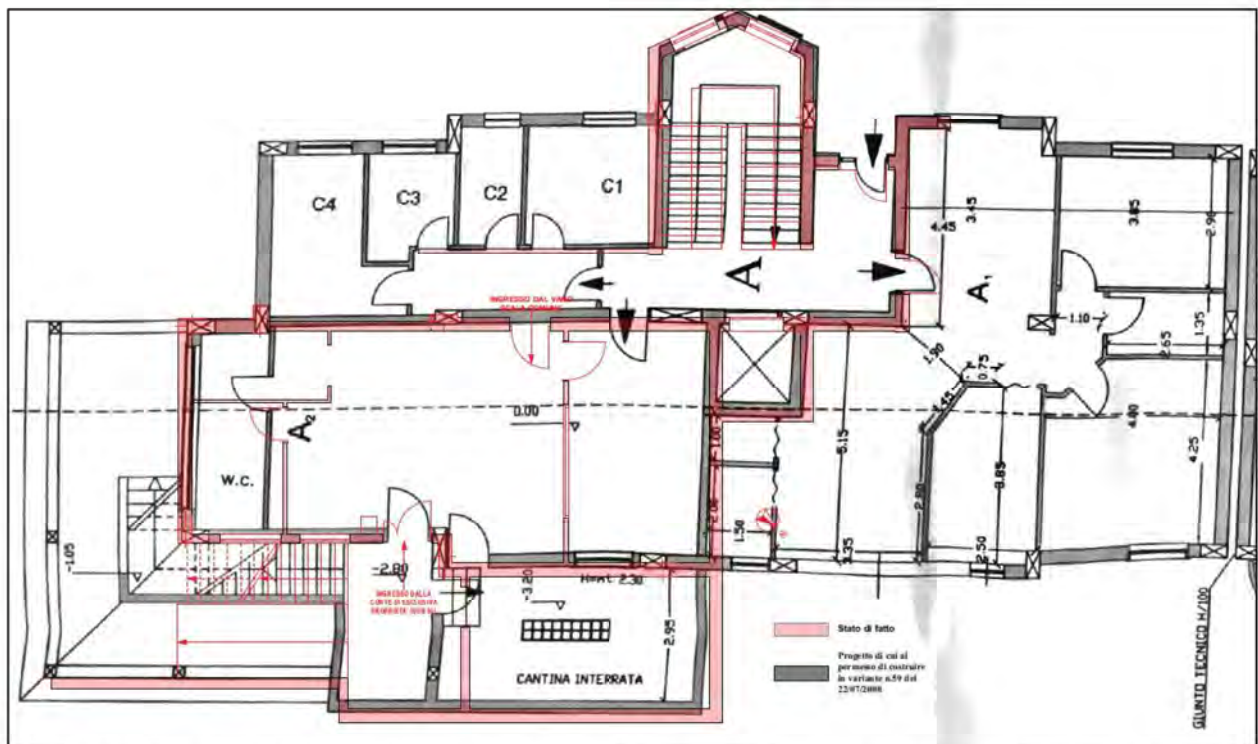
Pianta stato di fatto sovrapposta alla pianta del piano terra del progetto approvato con permesso di costruire in variante n.59 del 22/07/2008.
